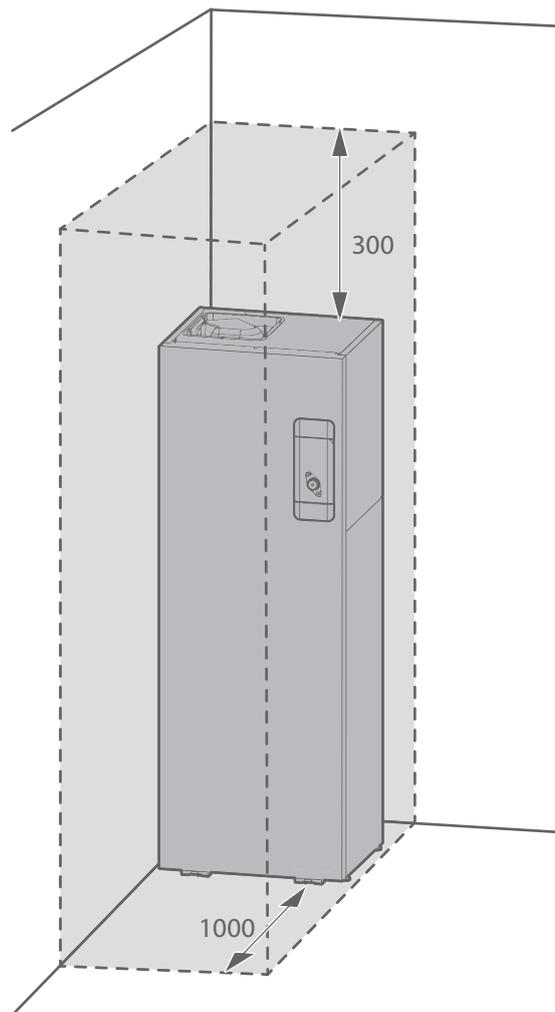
Installationsmindestfreiräume um das Hydraulikmodul im Hinblick auf die Wartung
